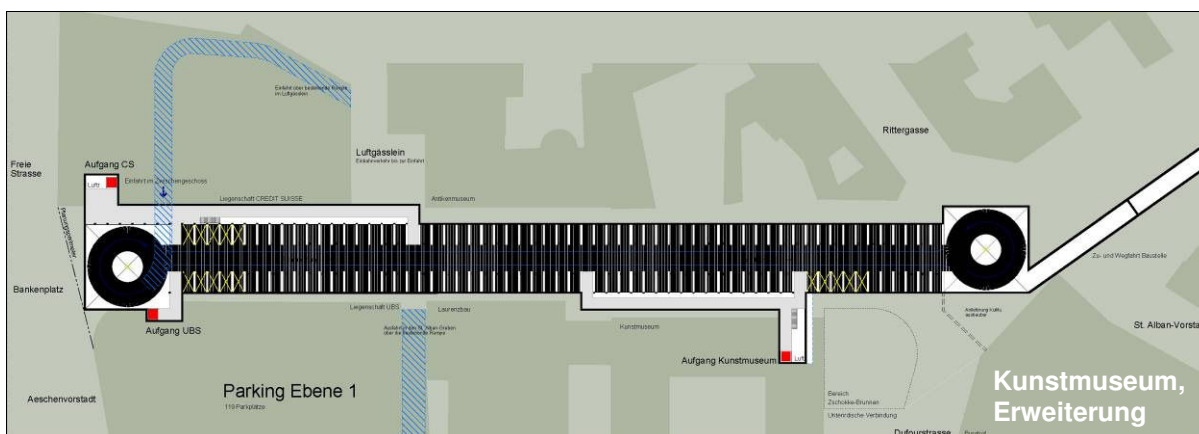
Entwurf Bebauungsplan Parking „Kunstmuseum“. Stand 2010.
